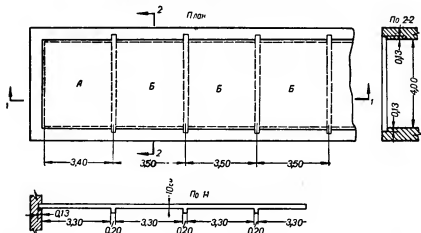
77. Схема железобетонного перекрытия с плитами, опертными по контуру.
